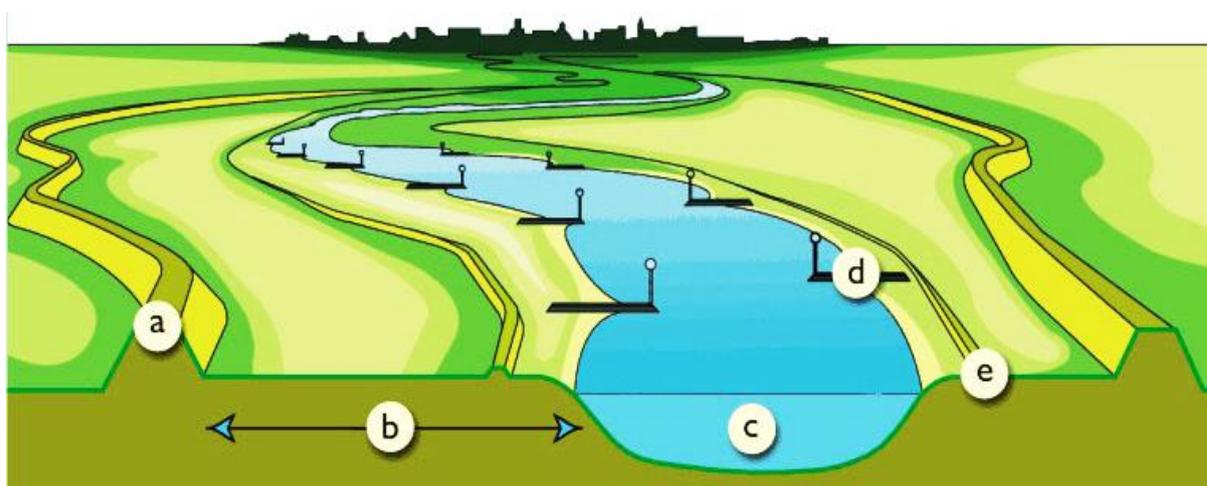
Схема расположения двухрядных обвалований и противопаводковых бун для защиты от наводнений вдоль рек в Нидерландах [37]: а – зимнее обвалование; b – пойма; c – русло реки; d - бунны или струенаправляющие дамбы; e – летнее обвалование
